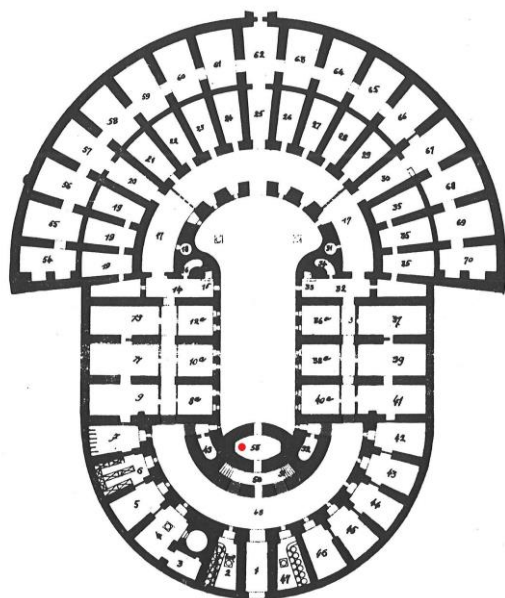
Grondplan reduit-ingang met aanduiding nachtrustplaats
